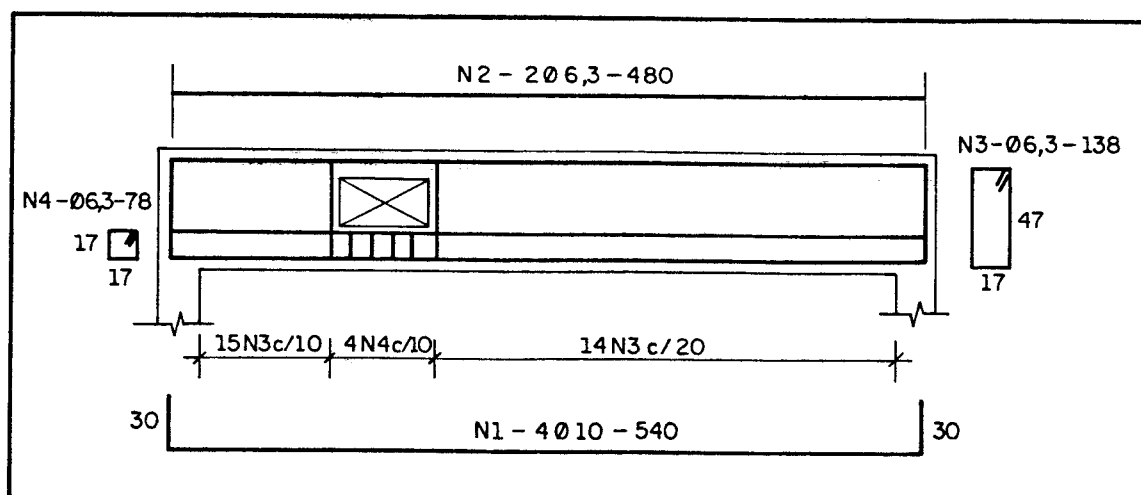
Detalhamento da viga com abertura do exemplo 9.
